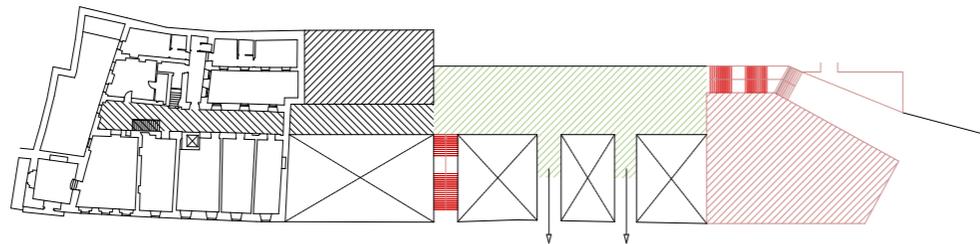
Baukörper Grundrisse OG, 1:1000
